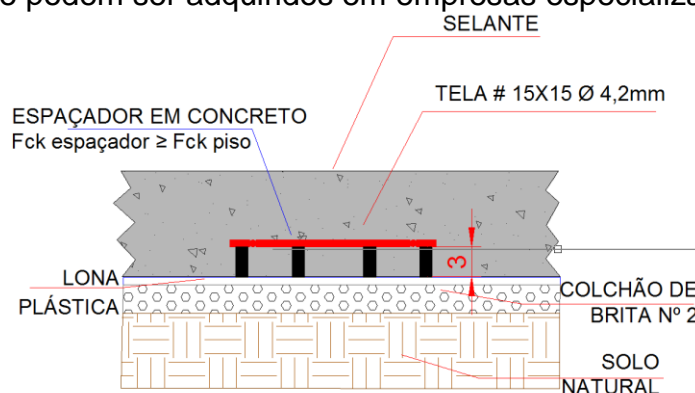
Corte do piso em concreto do passeio público e rampa de veículos leves
